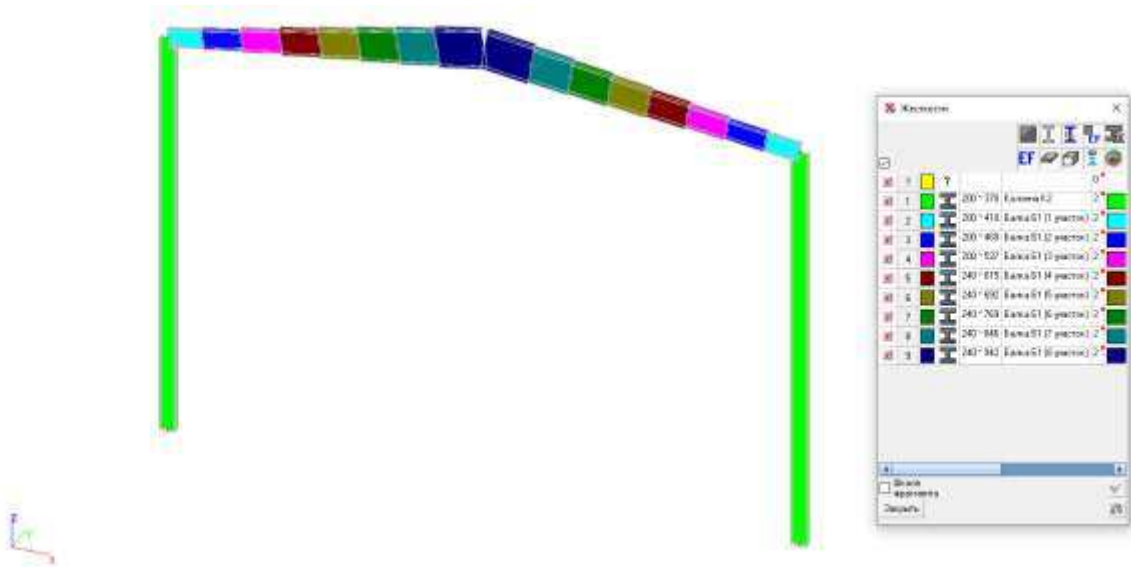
Расчётная схема поперечной рамы здания в осях 2/Б-В
